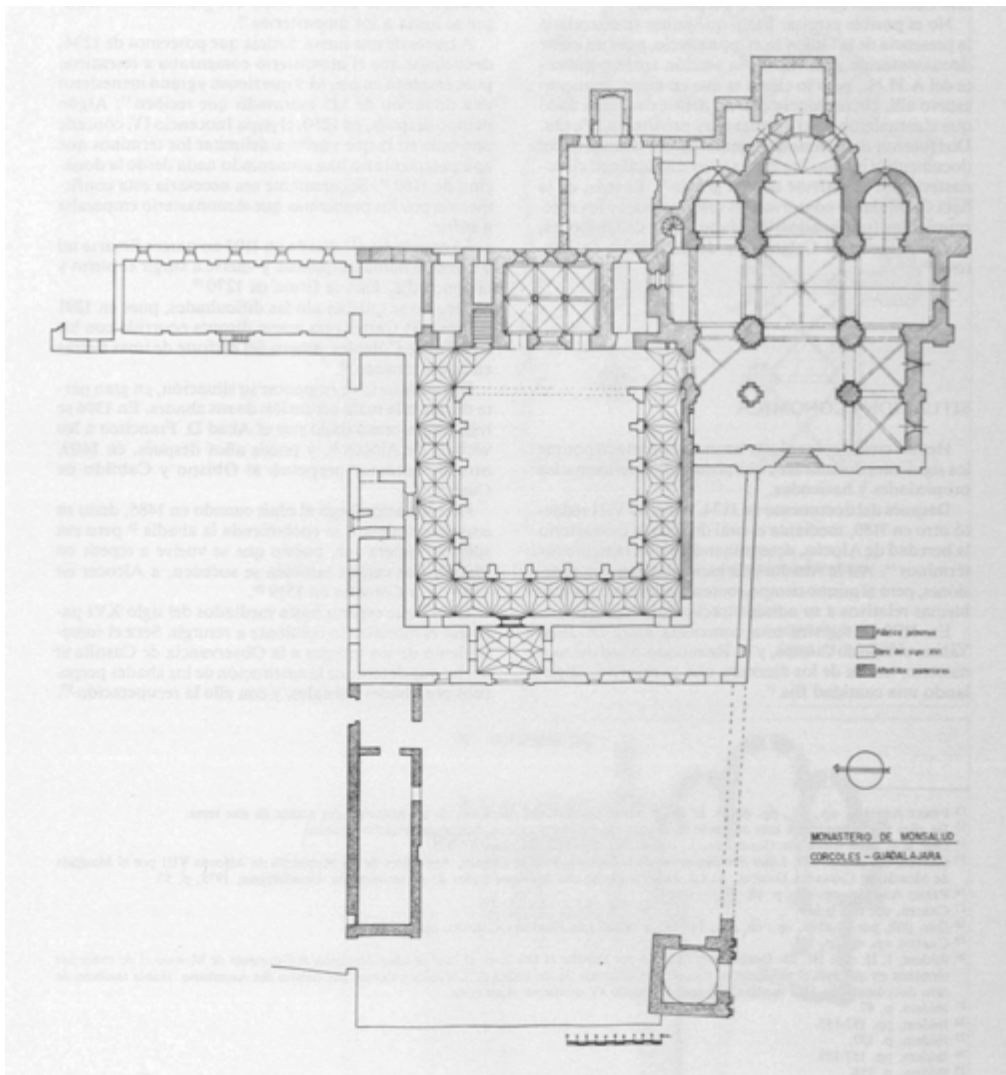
Monsalud, Santa María, Grundriss Gesamtanlage, Concepción Abad Castro, 1990.
